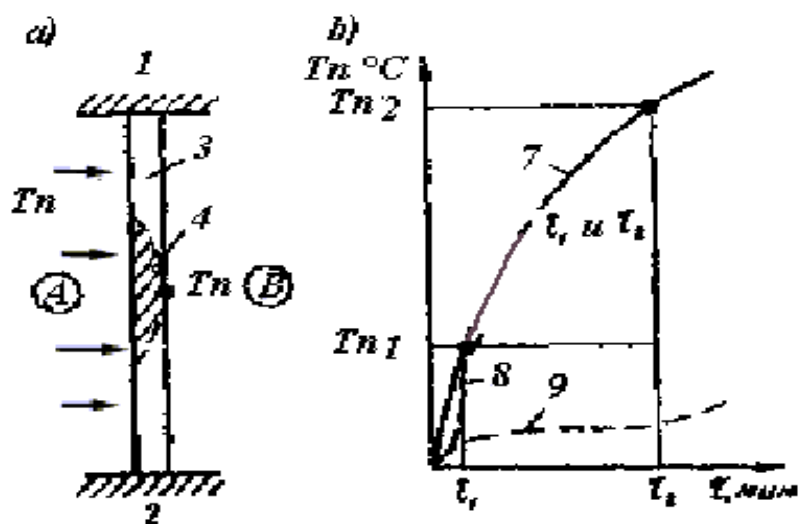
Влияние хрупкого разрушения бетона на предел огнестойкости ограждающей железобетонной конструкции: *а* - схема ограждающей конструкции; *б* - график зависимости температуры внутри помещения *А*, где произошел пожар, от времени; 1 - потолок (перекрытие); 2 - пол; 3 - ограждающая конструкция; 4 - отколовшийся кусок бетона; *А*, *В* - помещения, которые разделяет конструкция; 7 - зависимость температуры внутри помещения *А* от времени; 8 - то же, при хрупком разрушении бетона; 9 - то же, на поверхности ограждающей конструкции со стороны помещения *В*, когда нет хрупкого разрушения бетона
